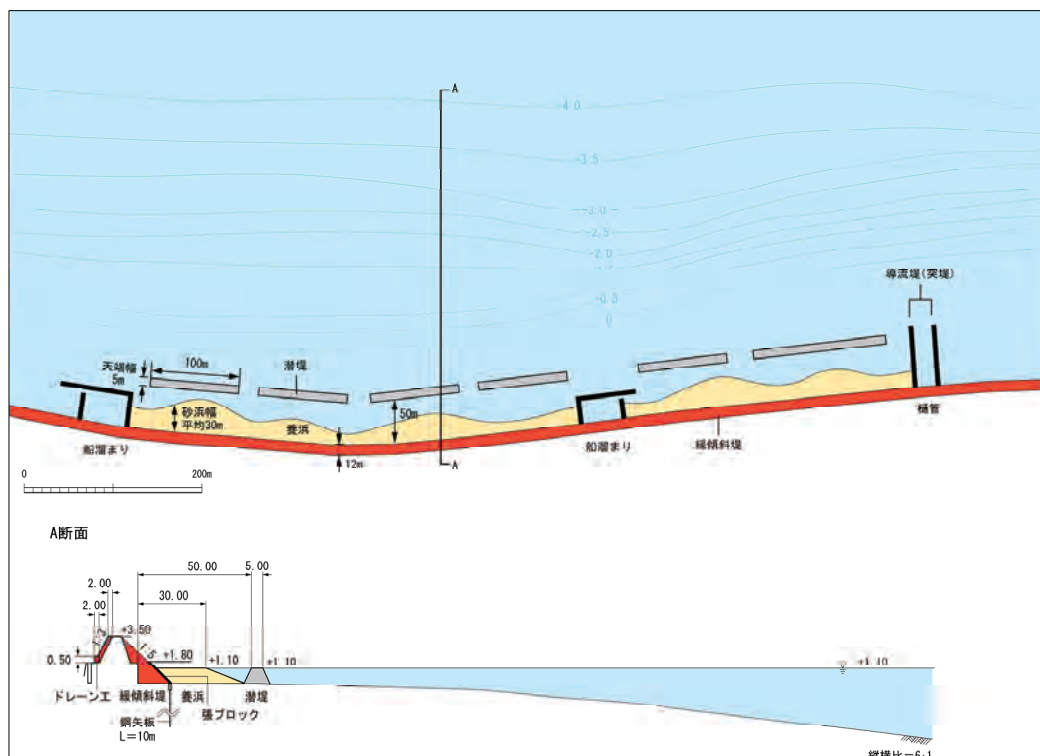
・7 A ゾーン 湖岸整備の平面配置および断面図案
